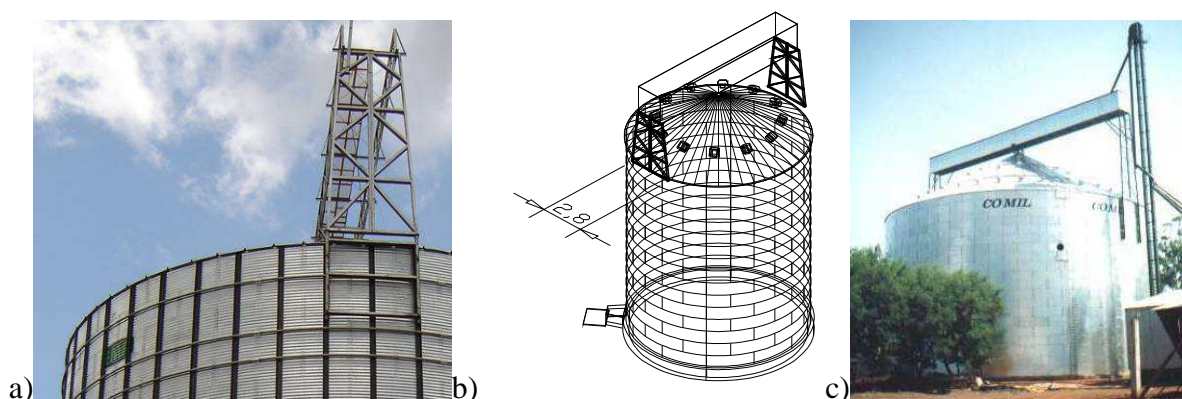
a) apoio pilar passarela nos montantes b) Esquema e c) Passarela Fechada sobre silo.
